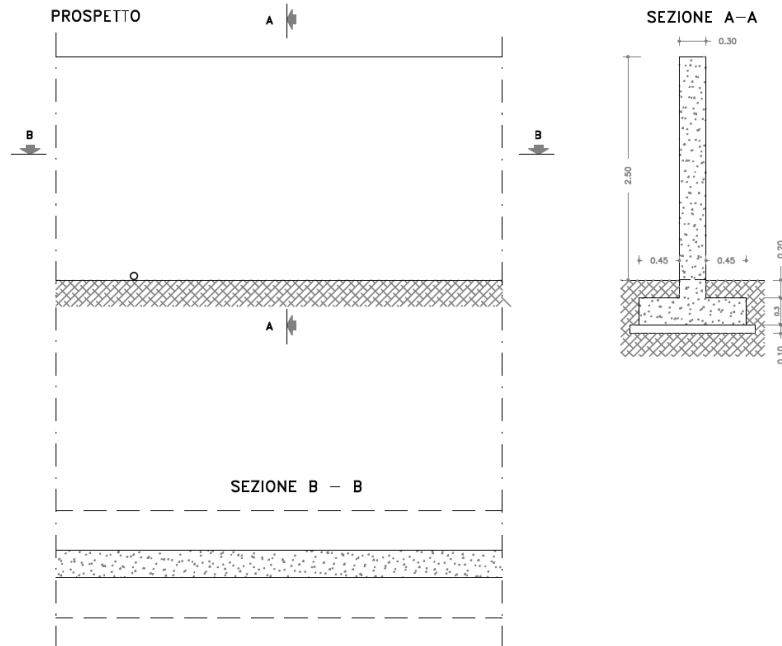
Prospetto e sezioni della recinzione di impianto.
